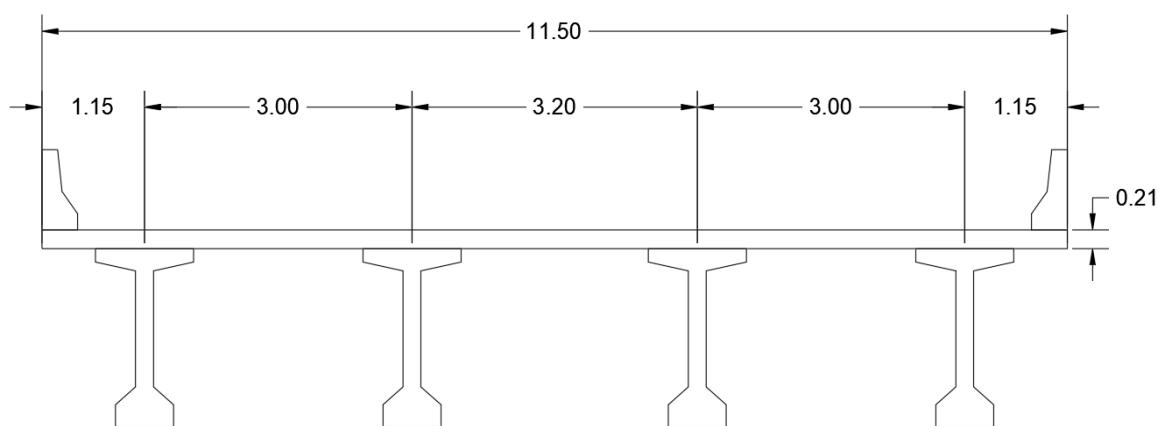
Seção transversal do tabuleiro da ponte em concreto protendido (dimensões em metros).
